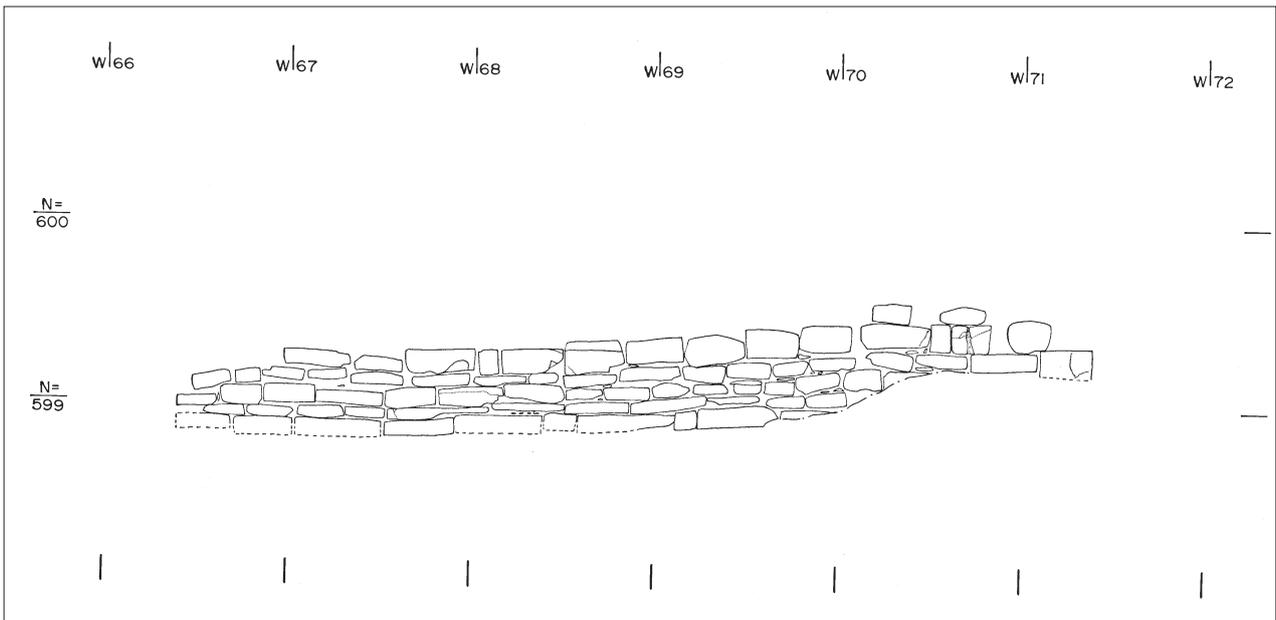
Fachada con vista al Sur de pared extremo Norte
